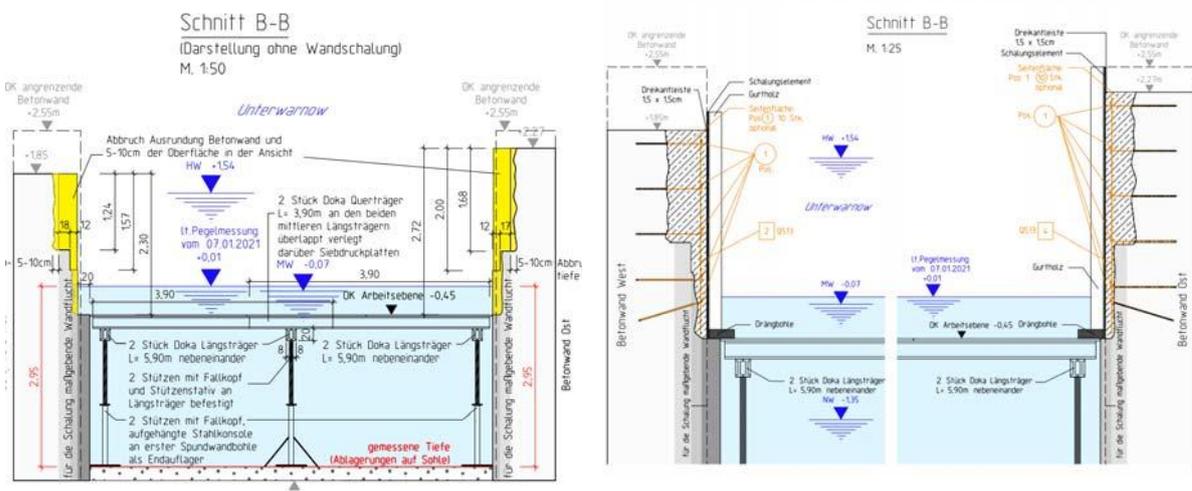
Sanierung der Betonwände unterhalb der Mühlendammbücke (WSV, April 2021)
